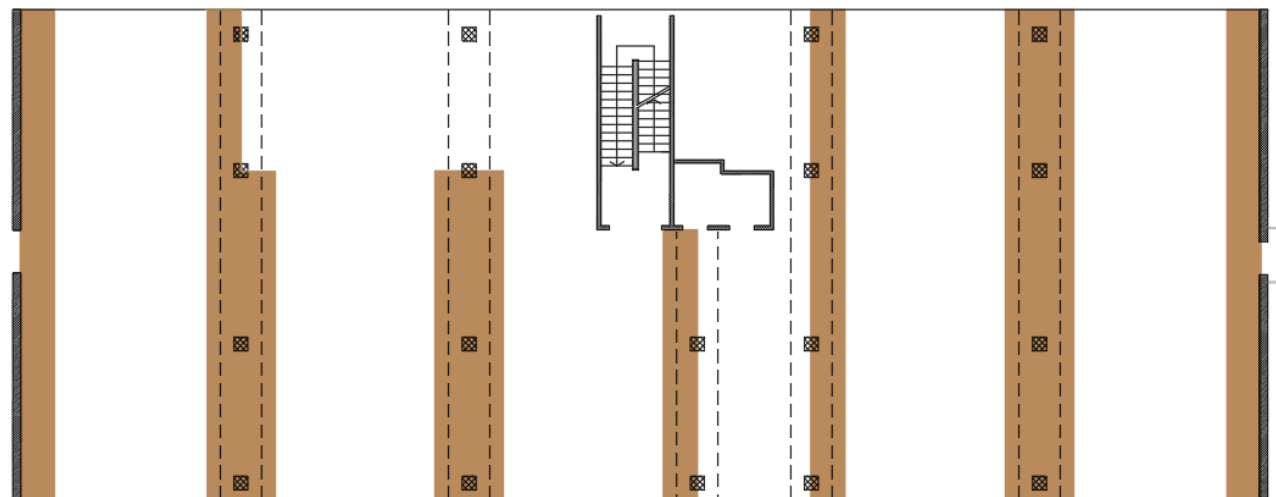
KEY PLAN RINFORZI A TAGLIO SOLAI
